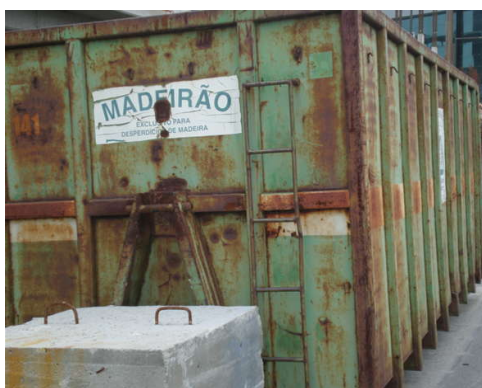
e 26 – Exemplos de “ecopontos” da fase de estruturas da obra adjacente ao Estádio do Dragão
